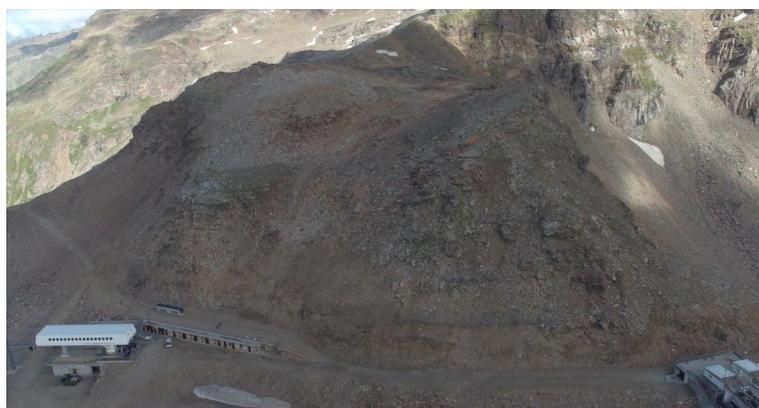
La stazione di arrivo a monte dell'impianto esistente al Passo dei Salati
